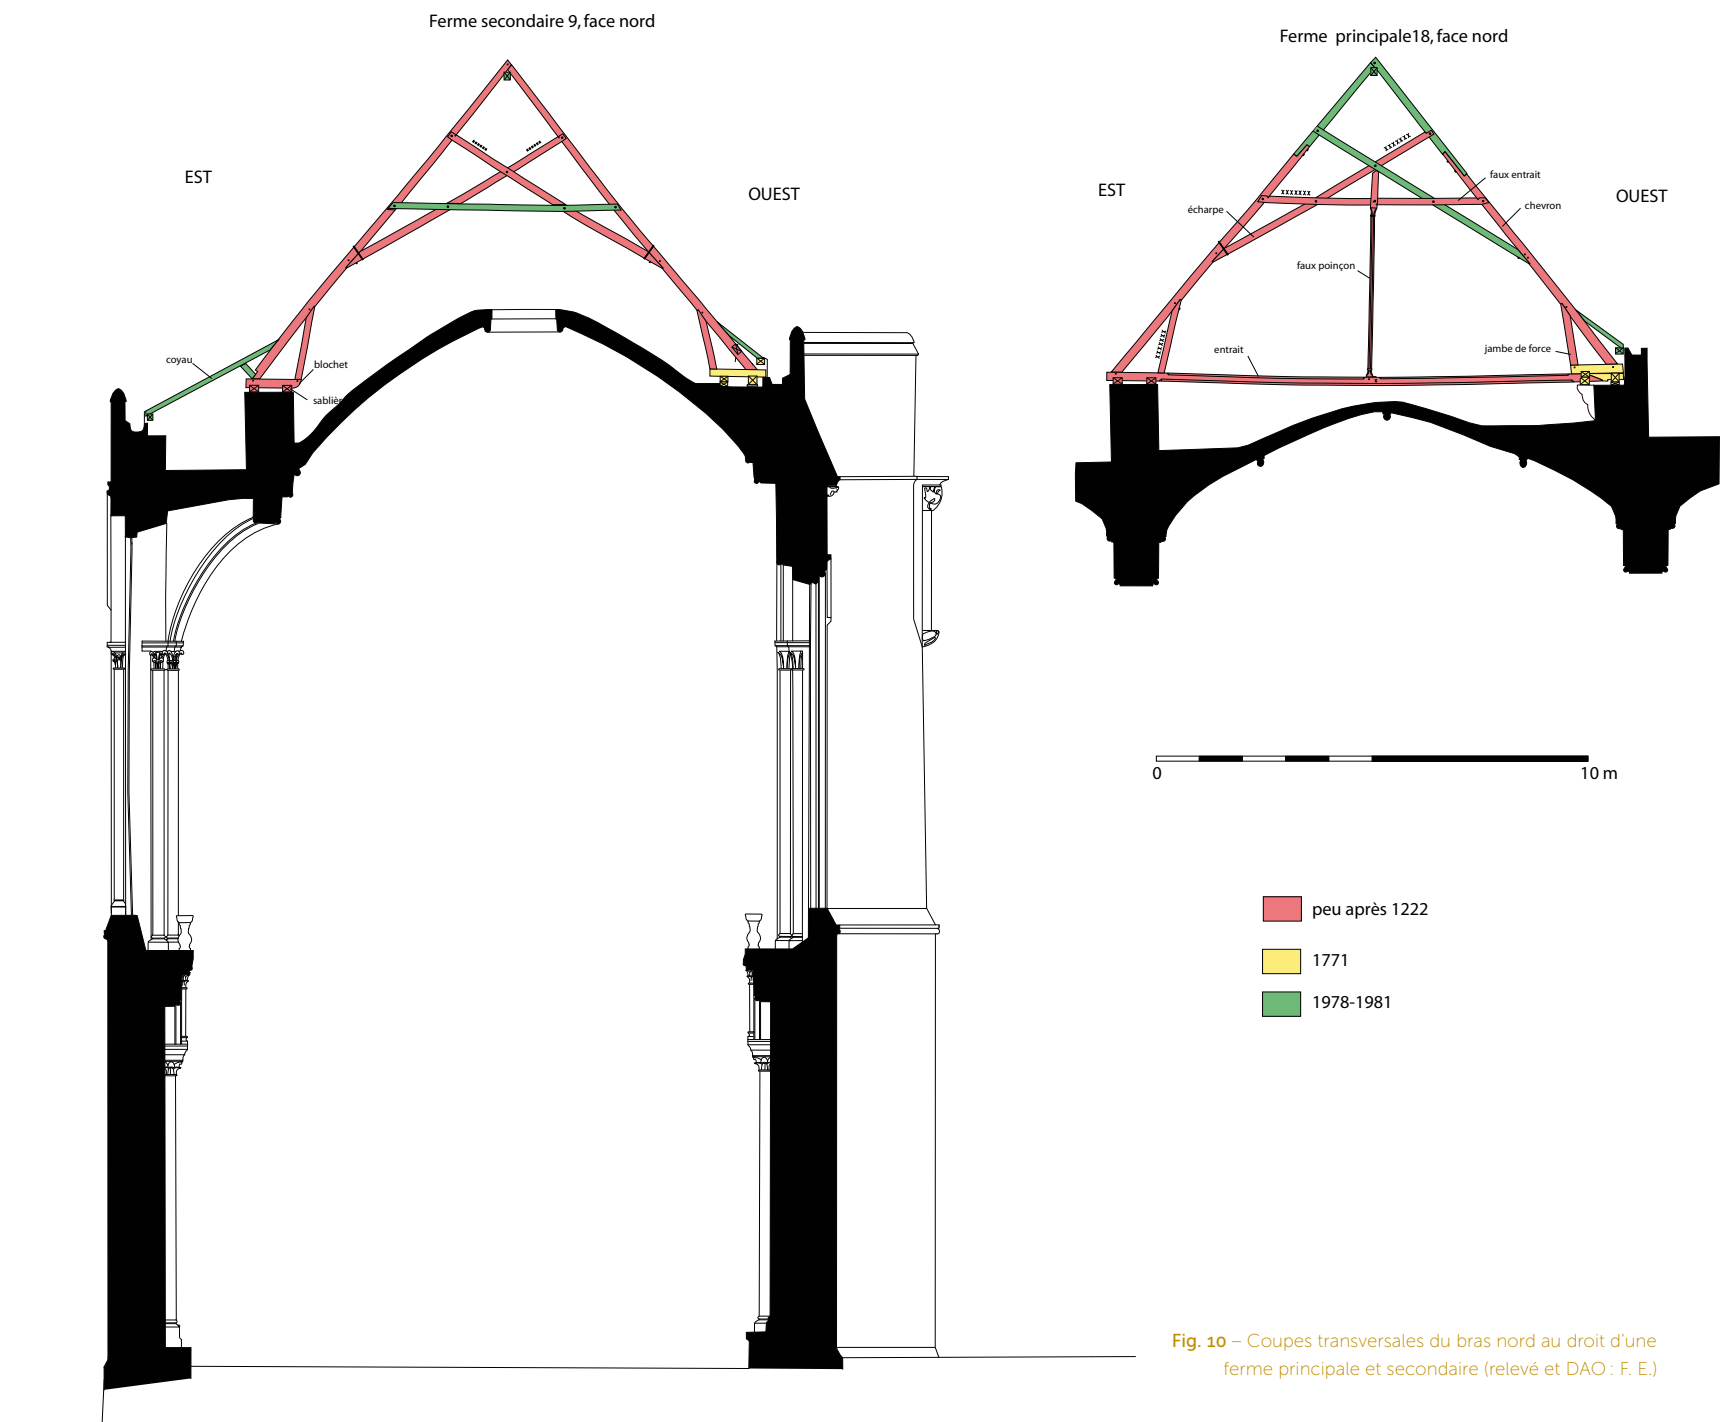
Coupes transversales du bras nord au droit d'une ferme principale et secondaire (relevé et DAO : F. E.)
